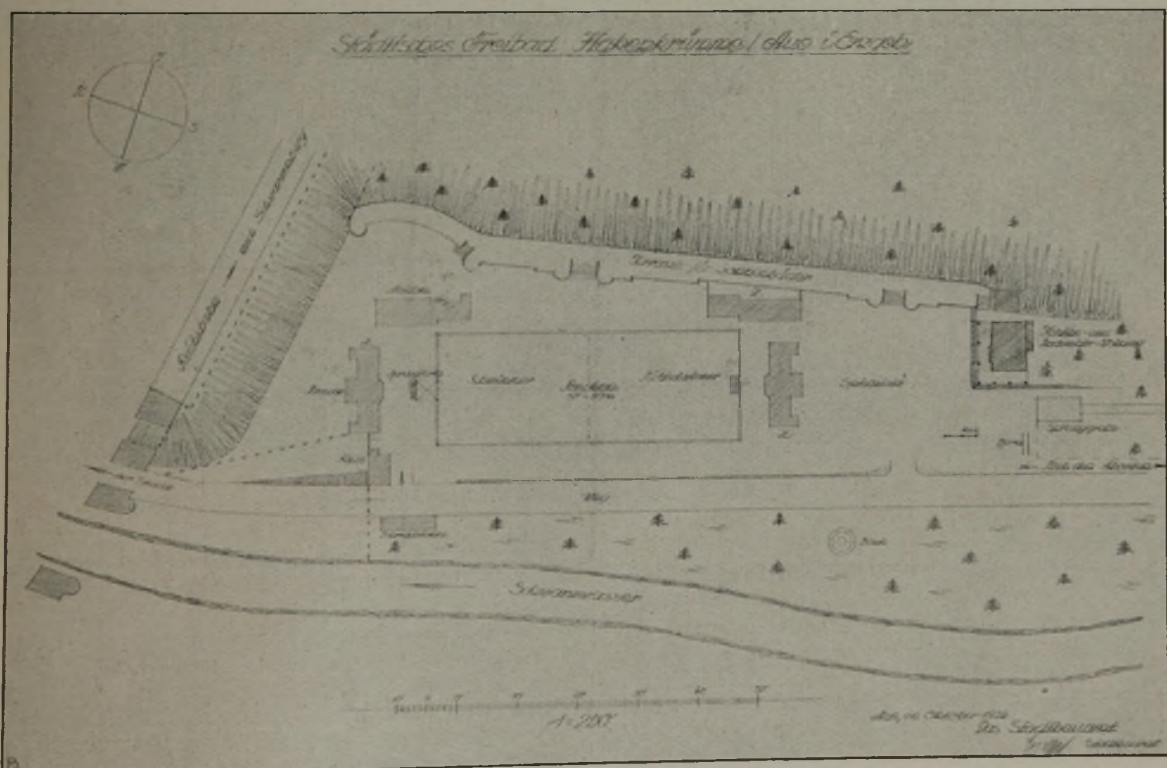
Lageplan. (Maßstab 1 : 1250.)
